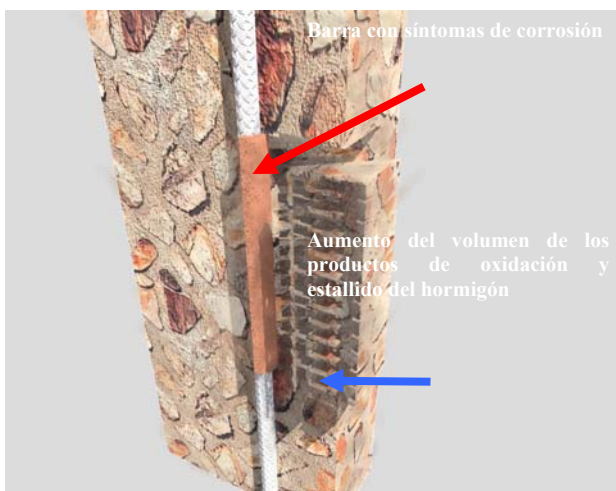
Corrosión de la armadura y estallido de lajas de hormigón.
